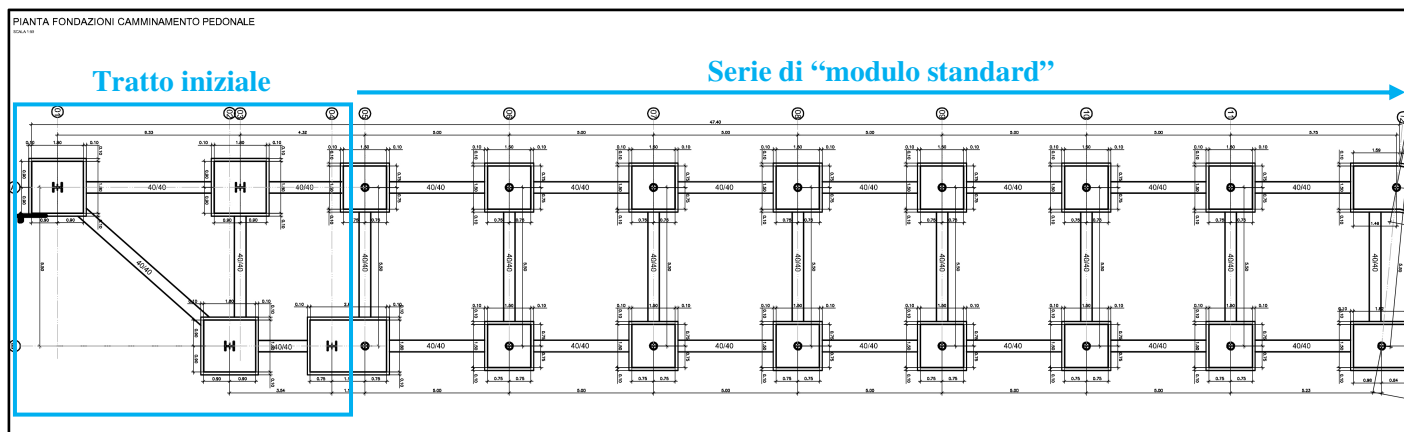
Estratto pianta delle fondazioni del Camminamento pedonale
